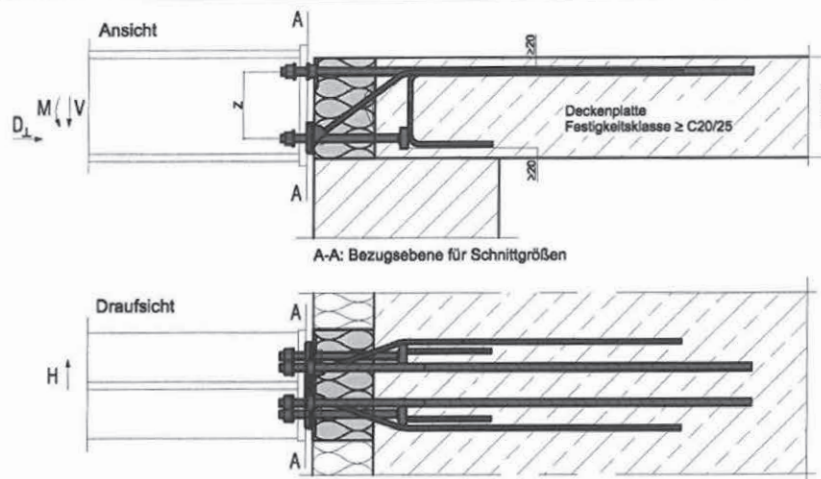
und 66: Schöck Isokorb® Typ KSXT14 V8, Schnittgrößendefinition
